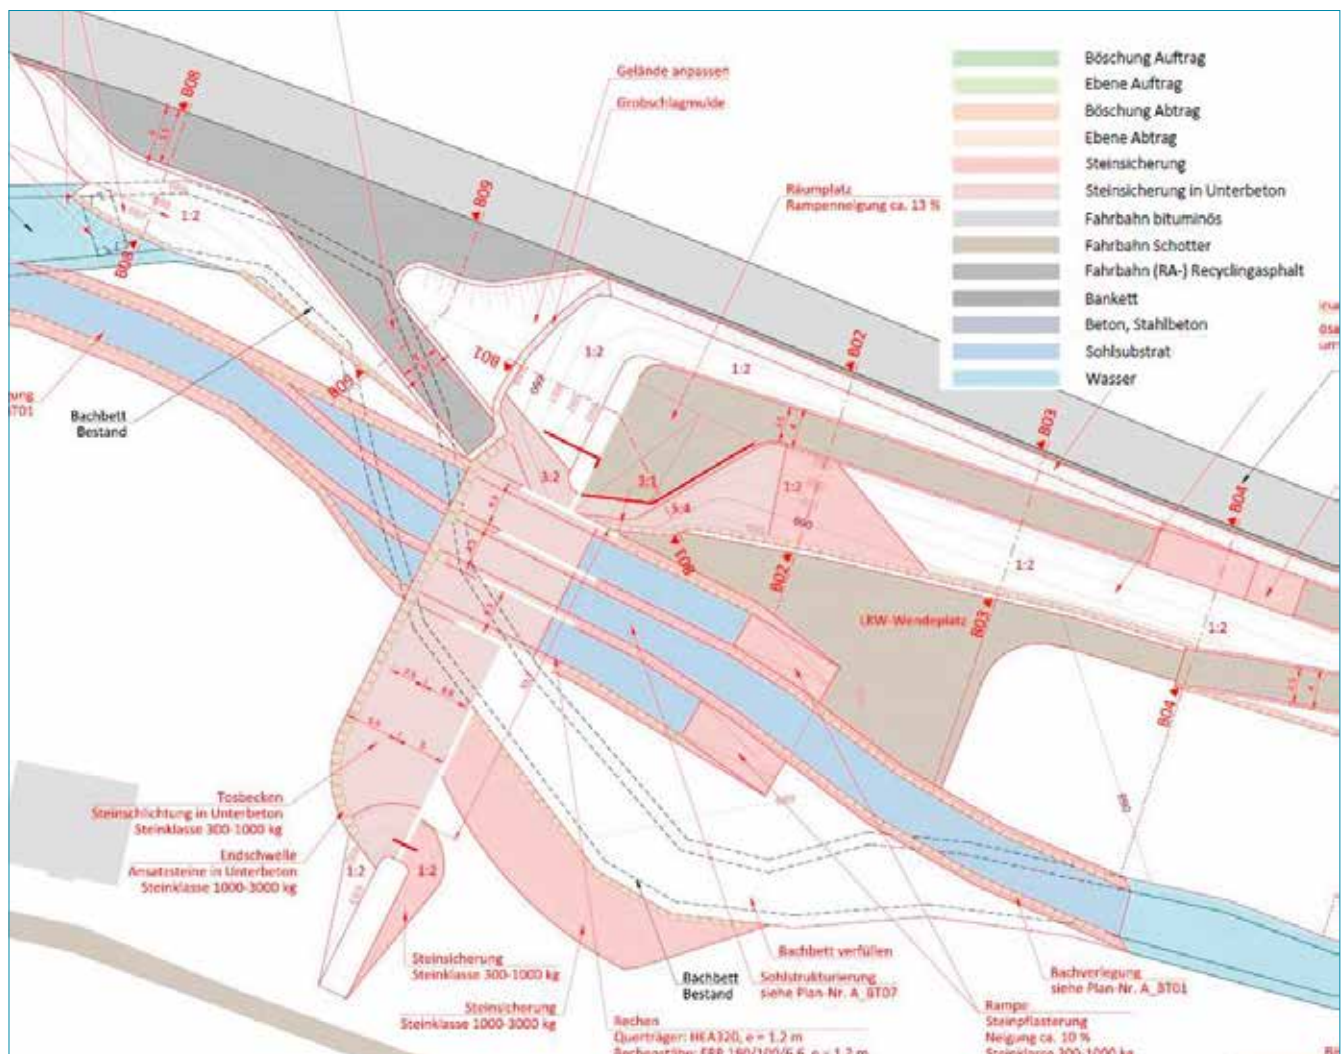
Ausschnitt Ausführungsplan Rückhaltebecken Fochnitzbach © Kratzer ZT GmbH
